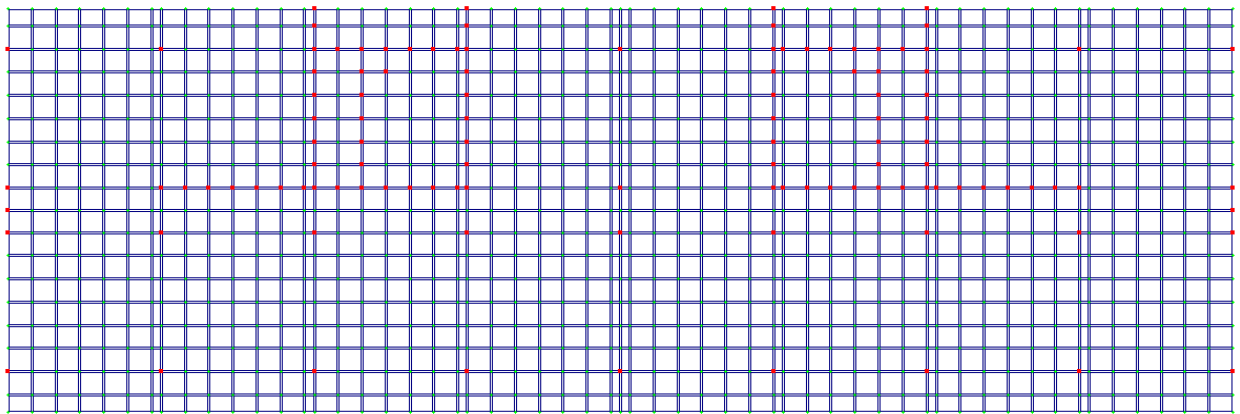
Узлы опирания расчетной схемы плиты
